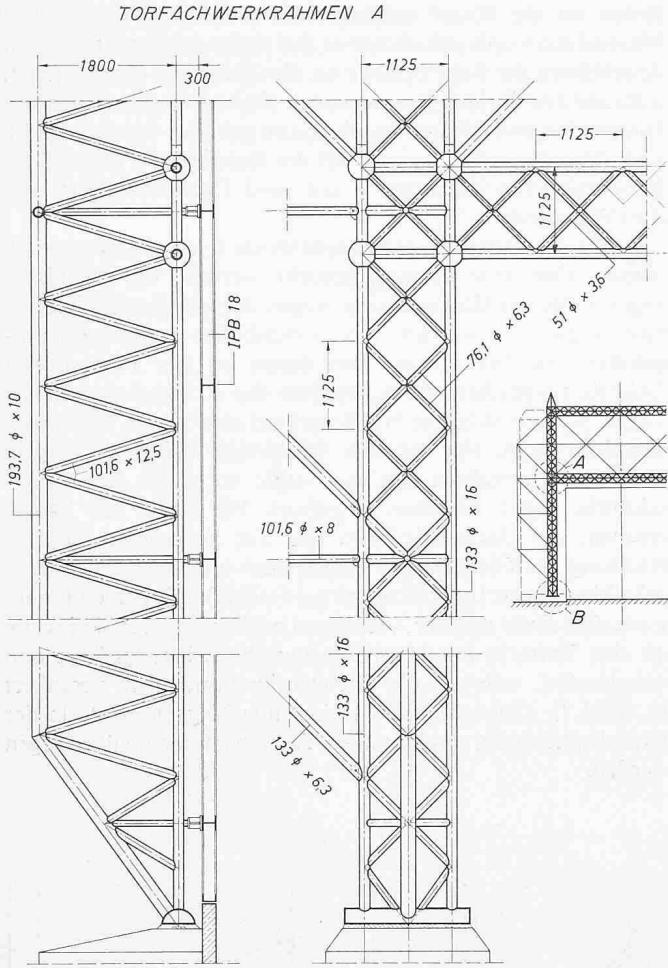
Eingespannter Stiel des Torrahmens, links Detail A und Fuss, Massstab 1:100, oben Horizontalschnitt 1:40, darunter Fussdetail B 1:40
